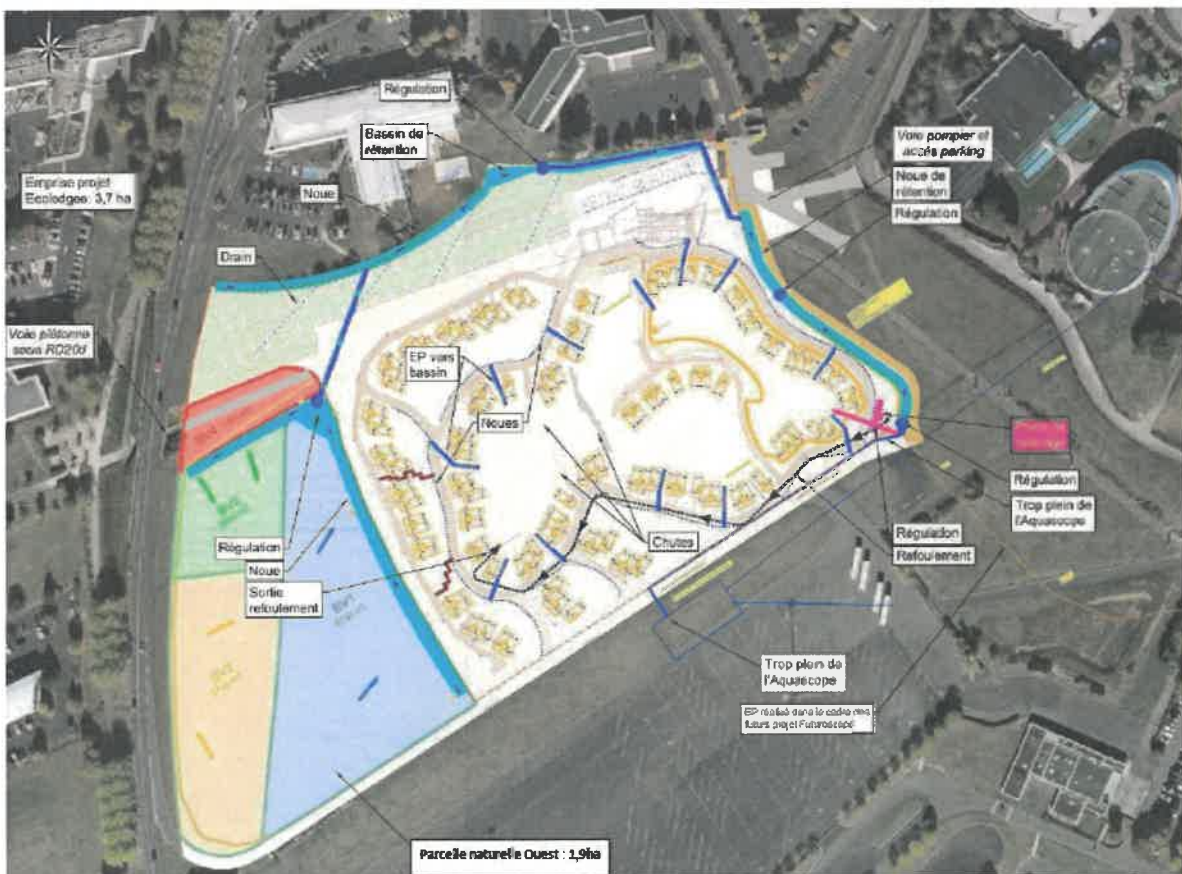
Plan de principe de gestion des eaux pluviales à l'état projeté sur l'emprise du projet Ecolodgee
